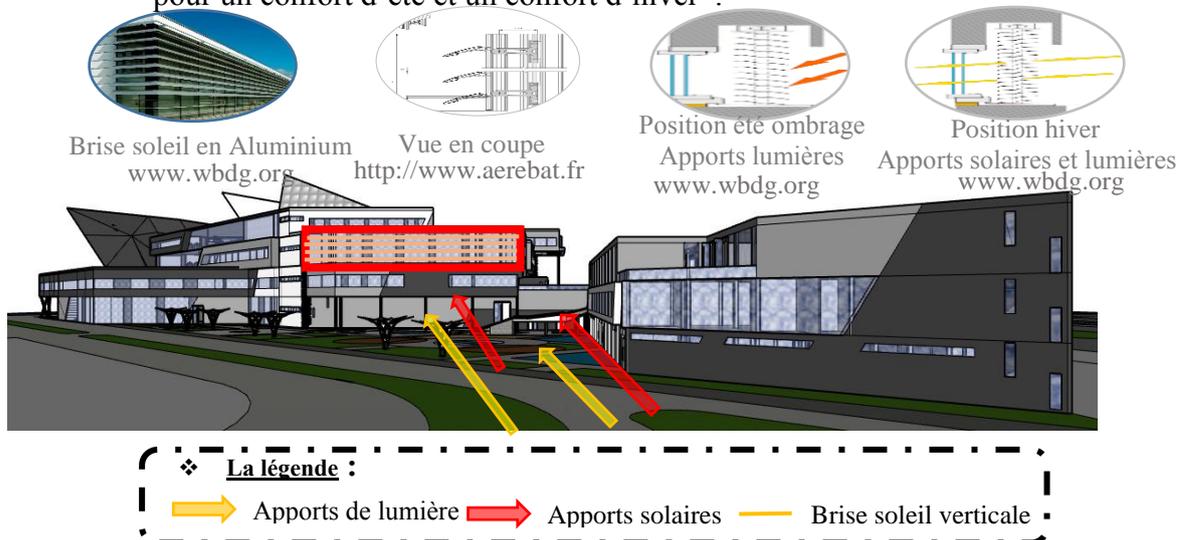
Schémas des brises soleil horizontales sur la Façade sud
